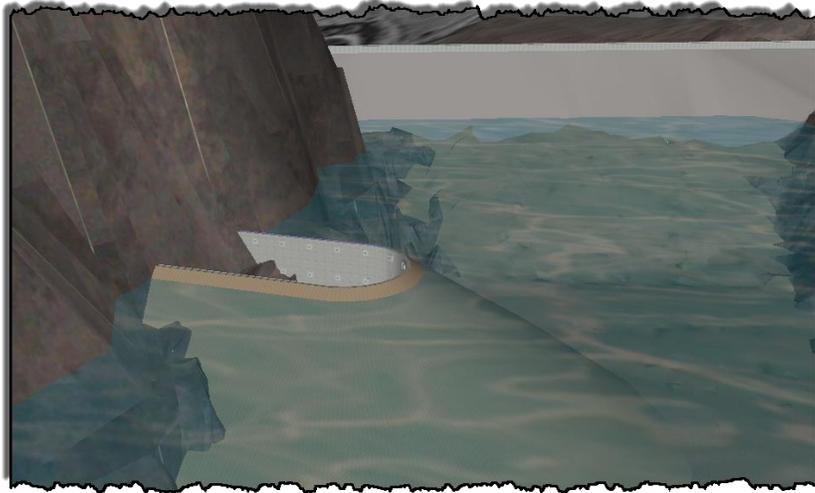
Vista de perspectiva del sistema ESTATEC para aislar la estructura de la obra de toma.
